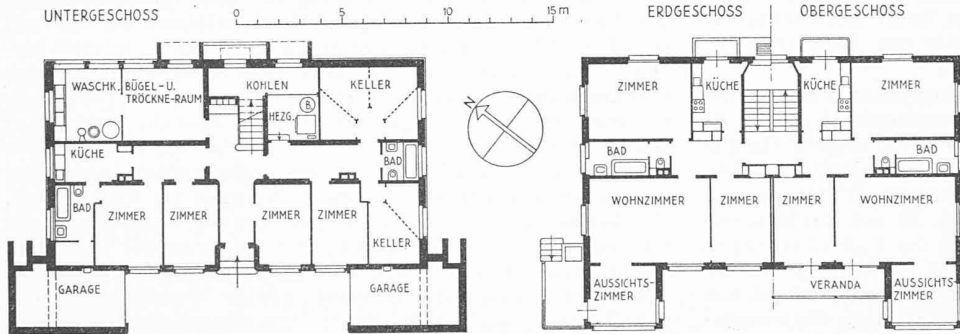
und 7. Grundrisse, Masstab 1:350
